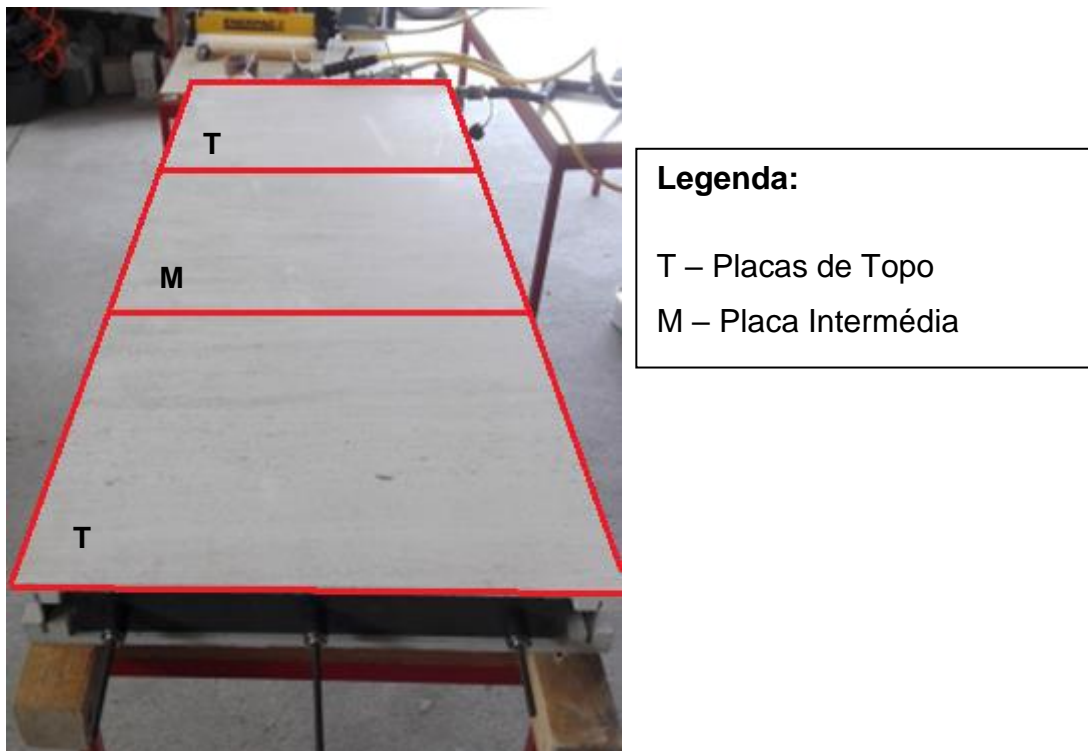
Disposição das placas integrantes da face exterior do sistema
